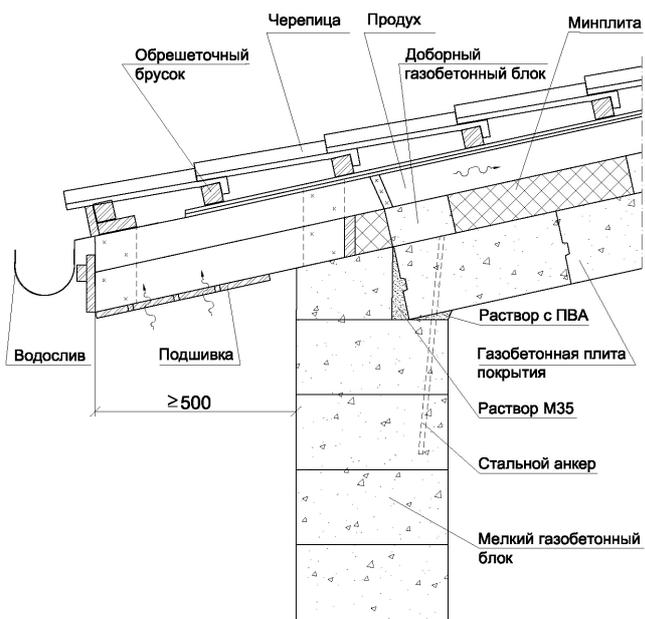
Узел примыкания газобетонных плит покрытий при устройстве совмещенной вентилируемой наклонной кровли
